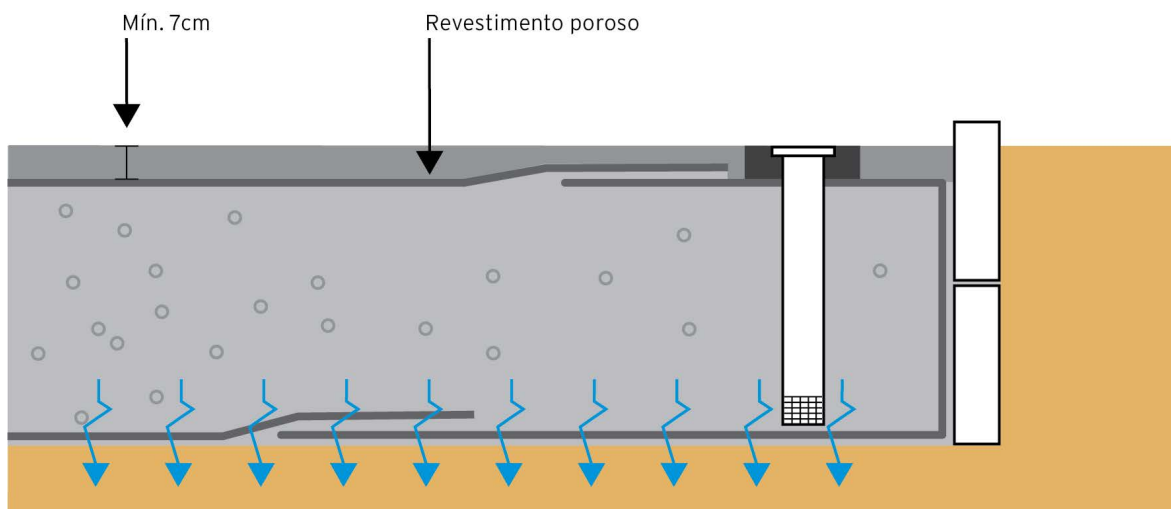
Seção típica de pavimento poroso, com infiltração, acabado. No caso de pavimentos sem infiltração, o fundo e as laterais são revestidos de material impermeável.
